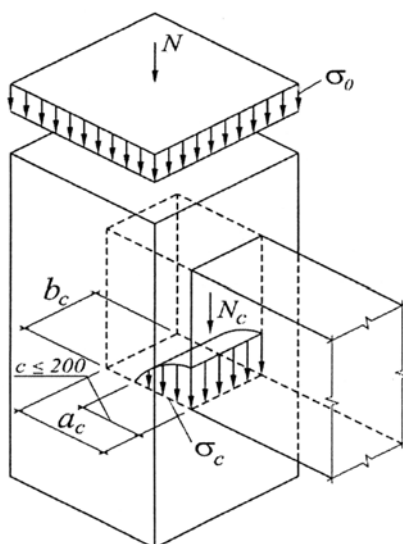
Схема нагружения кладки местной и основной нагрузками
